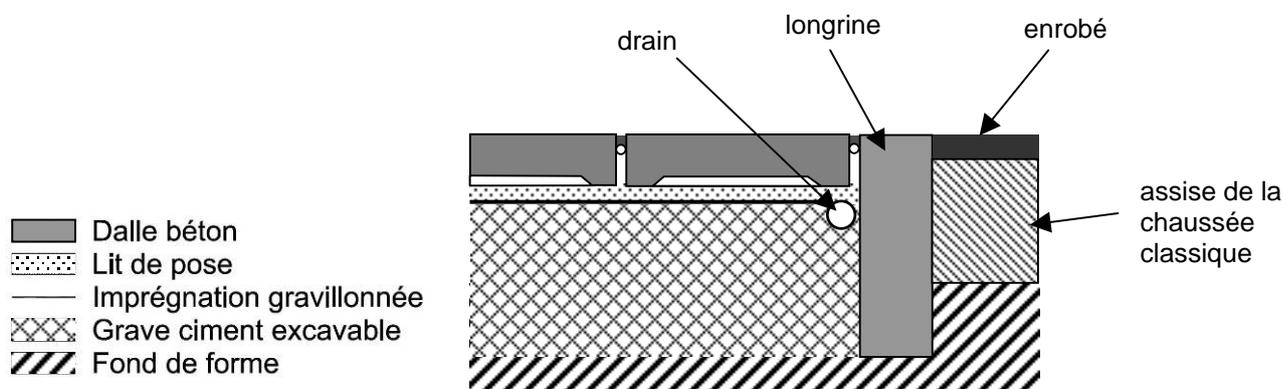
coupe longitudinale de principe d'une extrémité de CUD à dalles indépendantes
